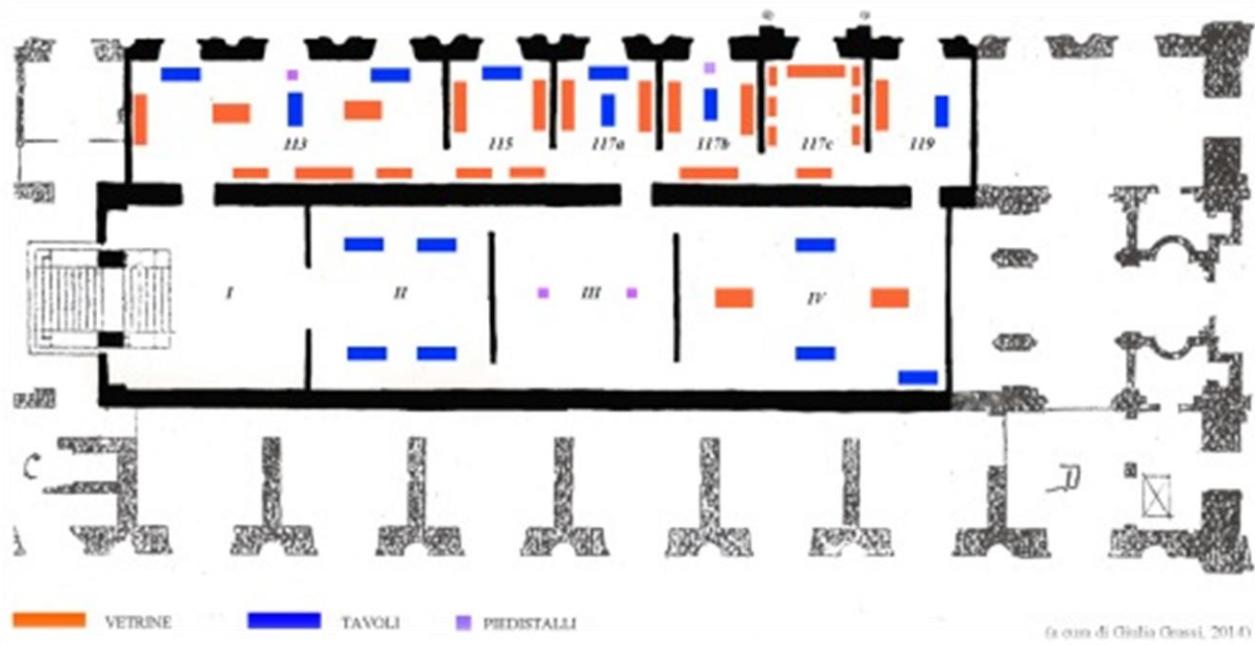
Pianta generale dell'esposizione al *Pavillon de Marsan* (a cura dell'autrice)
